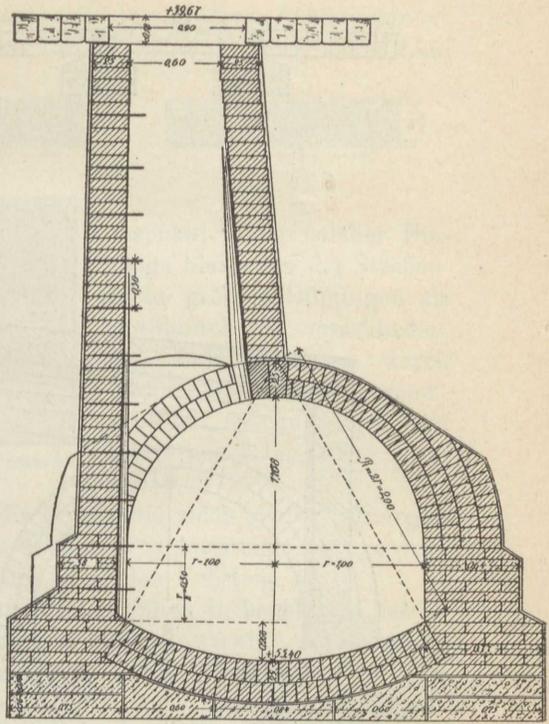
Einsteigeschacht eines größeren gemauerten Kanals (Haubenprofil).
